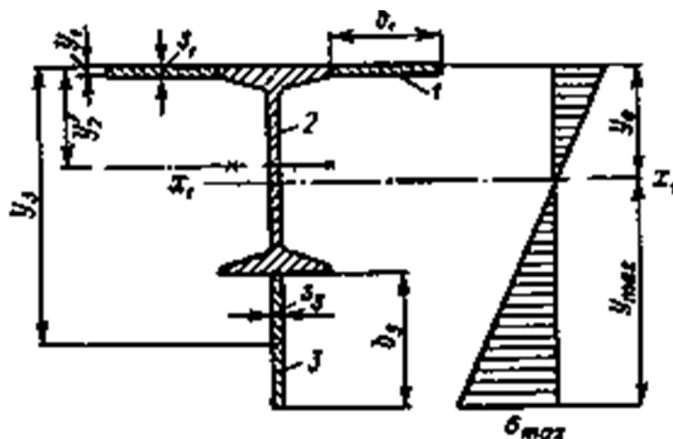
Схема прикрепления сечения неразрезной балки на опоре
